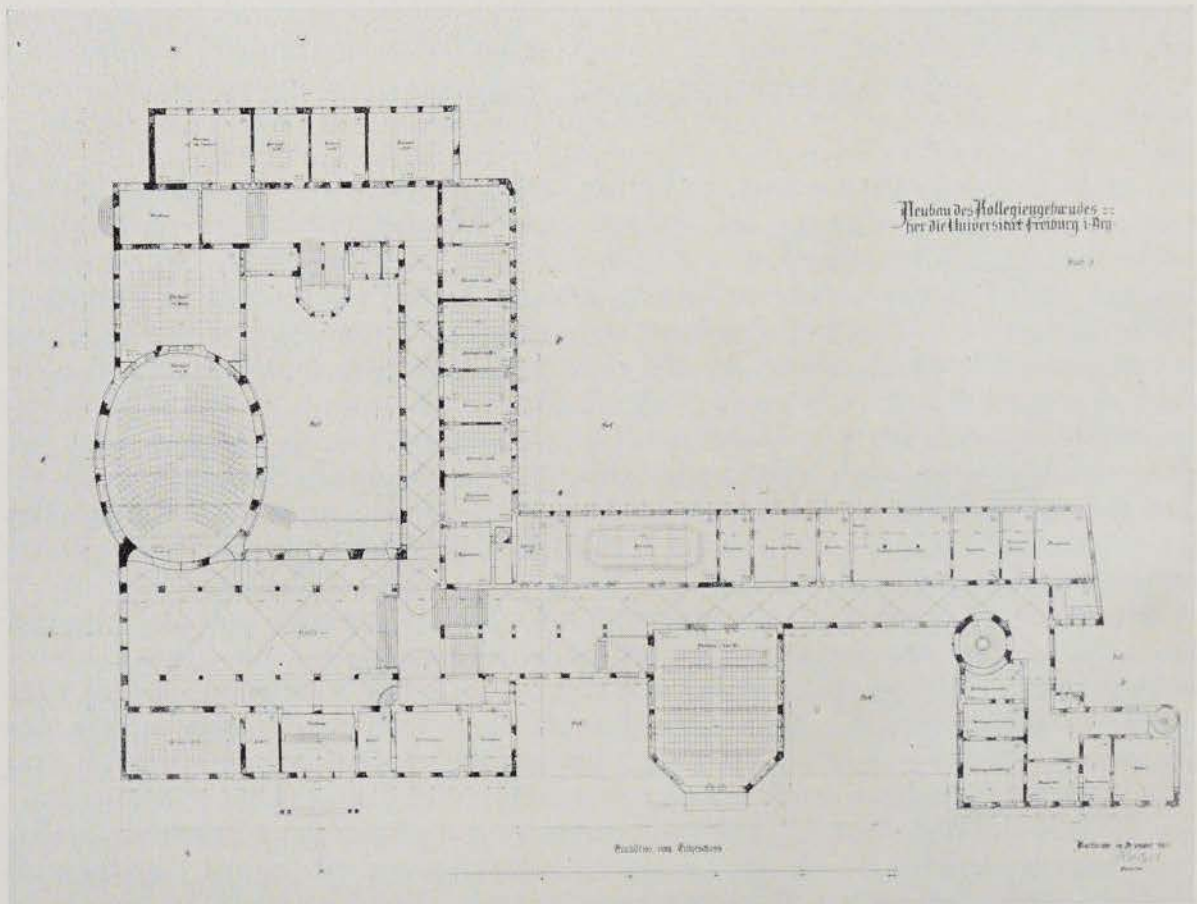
Kollegiengebäude, Grundriß des Erdgeschosses
